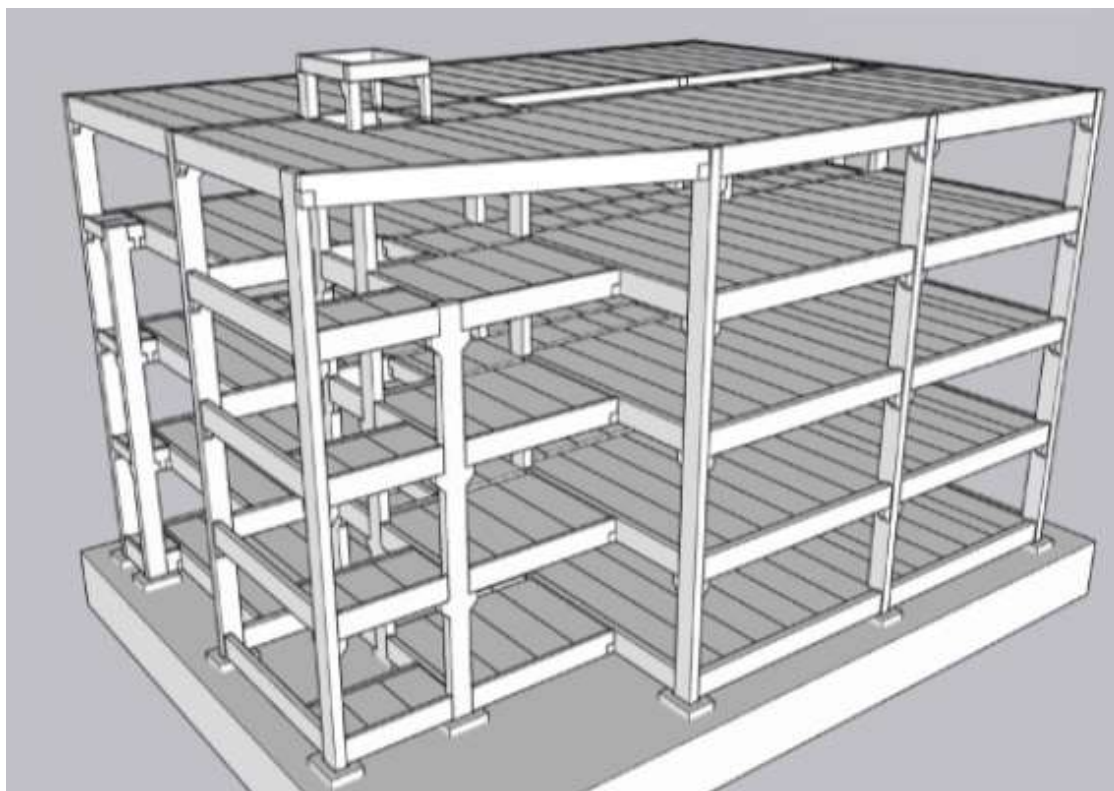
Perspectiva da estrutura pré-fabricada da edificação – Plano 2
